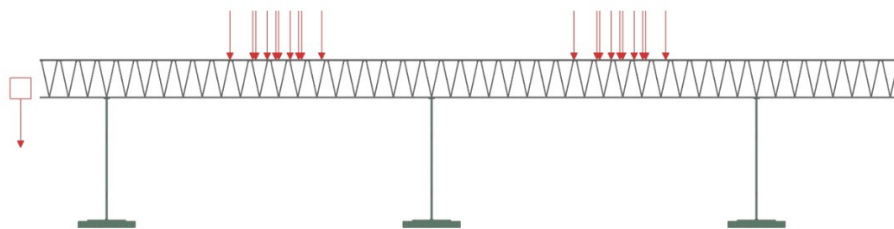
Coupe transversale d'un panneau (correspond à une voie) chargé par un camion CL-625 placé transversalement au centre de la voie
